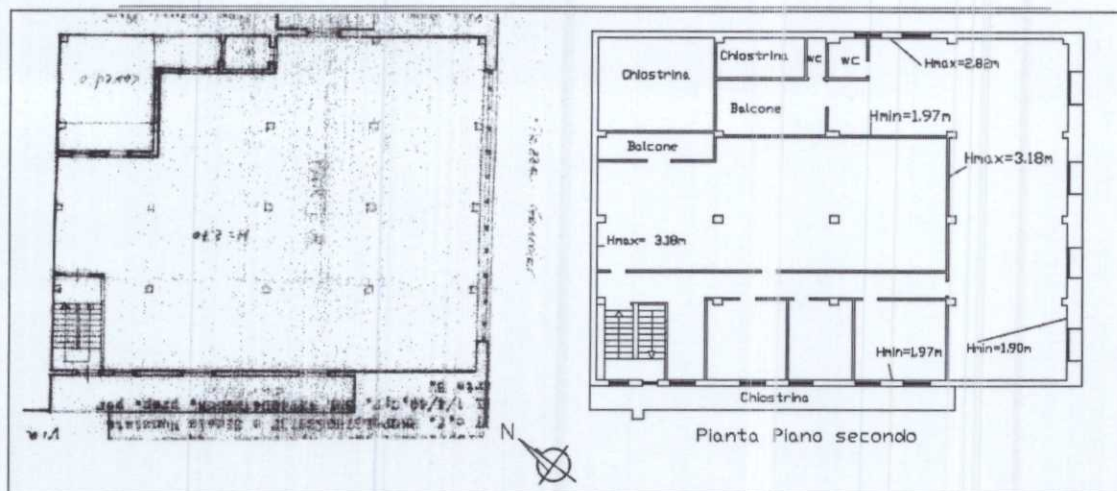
confronto tra la planimetria Catastale (sinistra) e la planimetria dello stato reale dei luoghi (destra). Pianta piano Secondo
